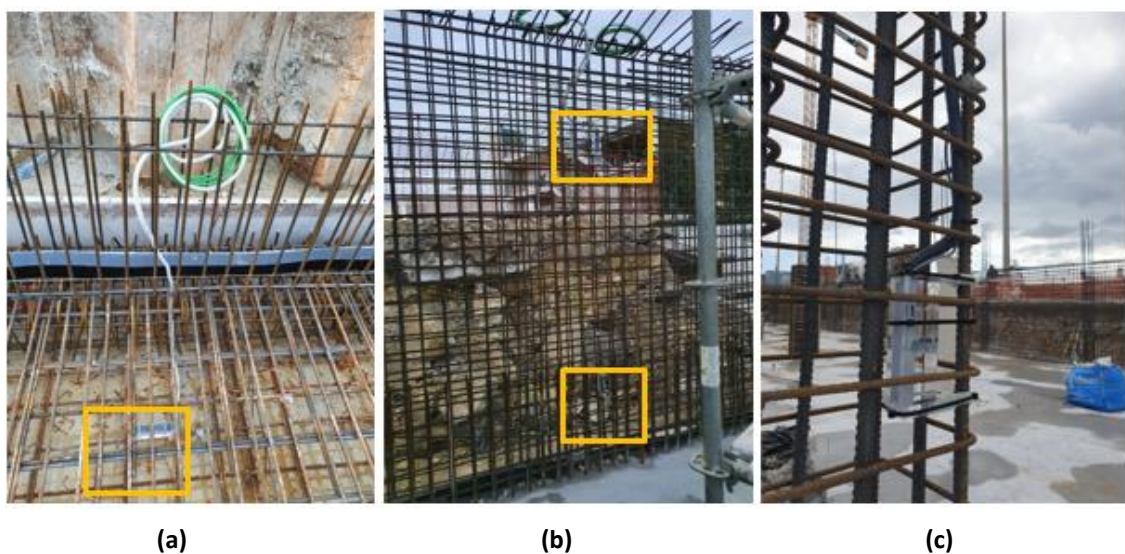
Colocación de sensores: (a) Losa. (b) Muro. (c) Pilar.
